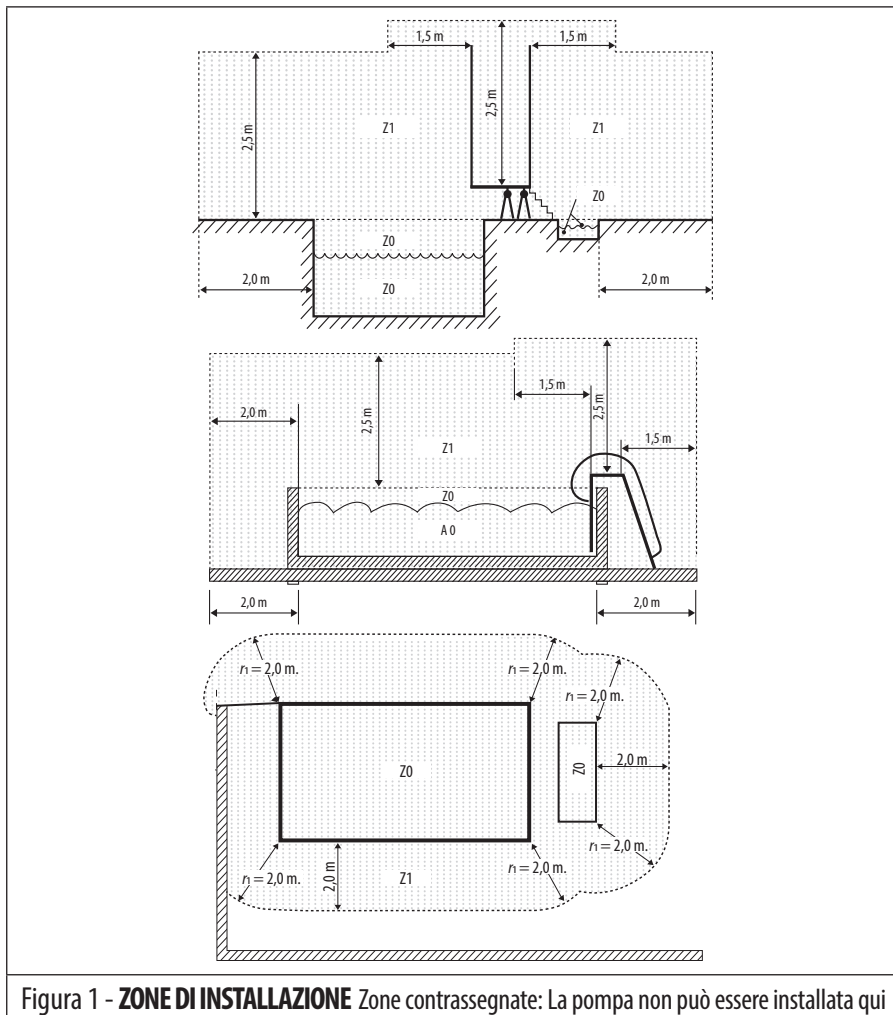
ZONE DI INSTALLAZIONE Zone contrassegnate: La pompa non può essere installata qui
